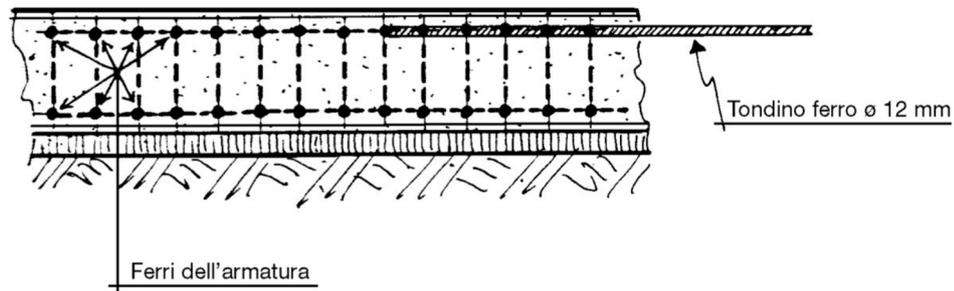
Esempio di platea di fondazione con connessione ai ferri dell'armatura
